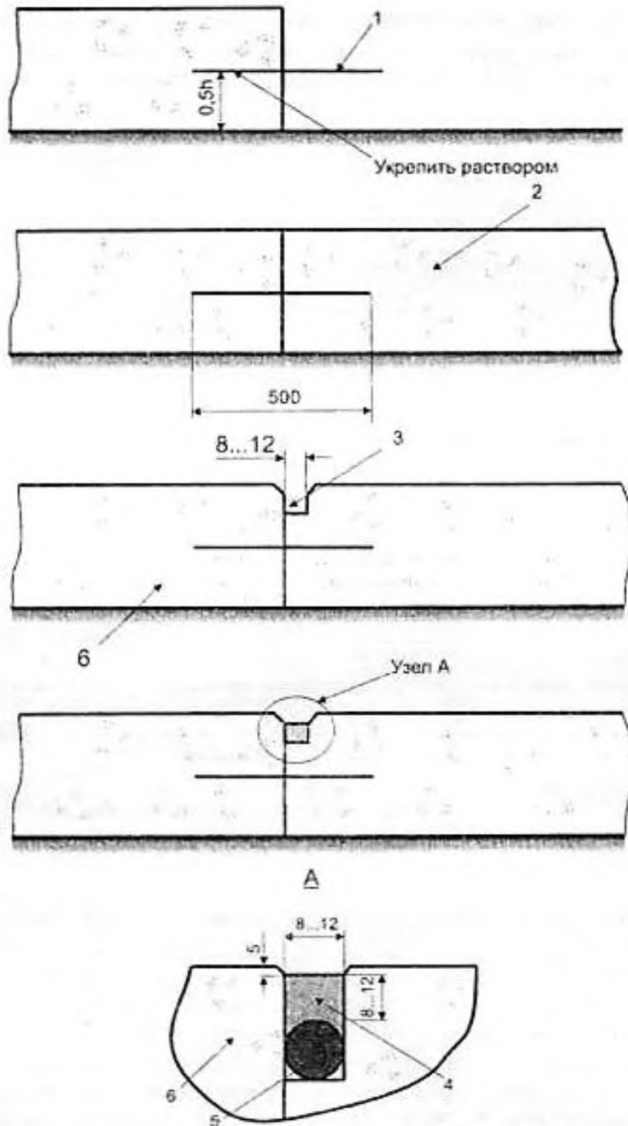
Конструктивная схема ложного шва: 1 - металлический анкер; 2- свежесуложенный бетон; 3- паз для герметика; 4 - герметик; 5 - уплотнительный шнур; 6 - смежная плита.
